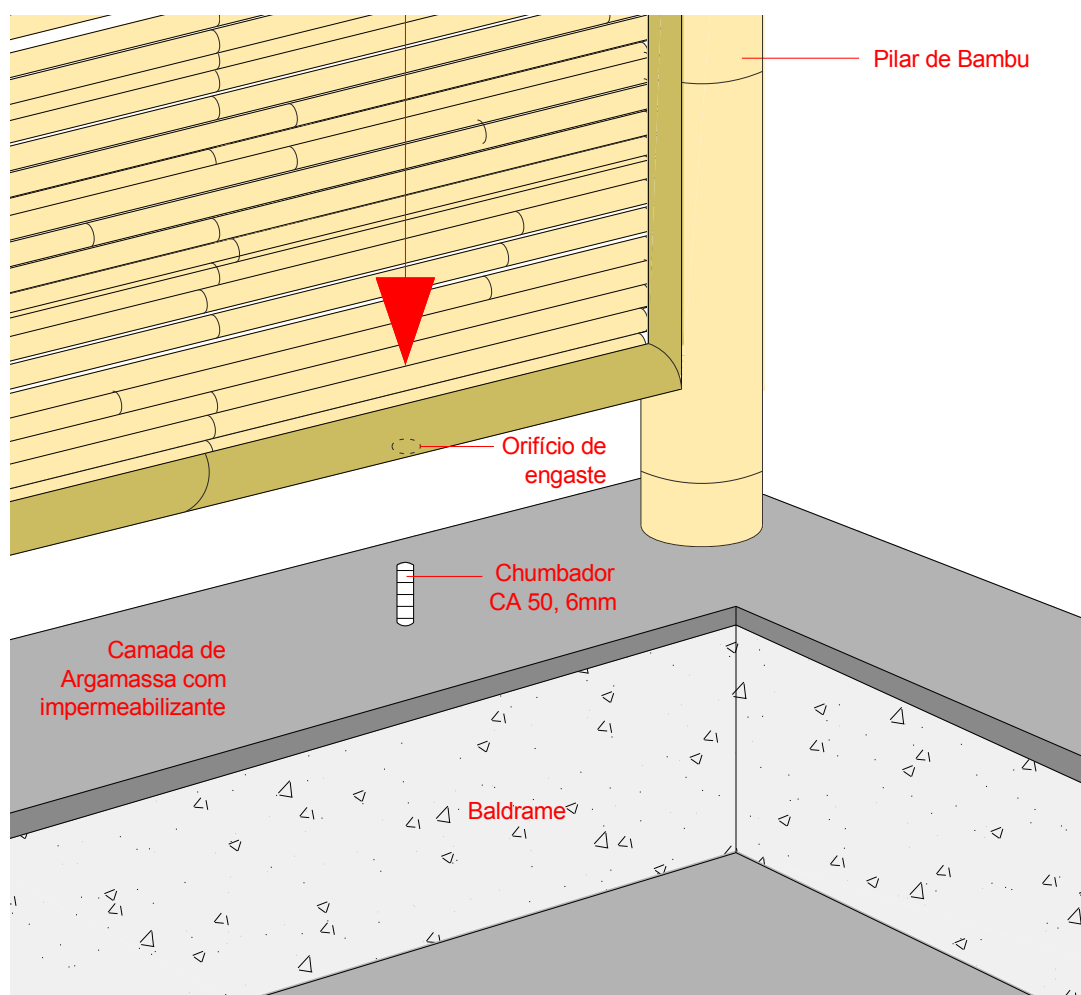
Detalhe da fixação do painel com a viga baldrame.
